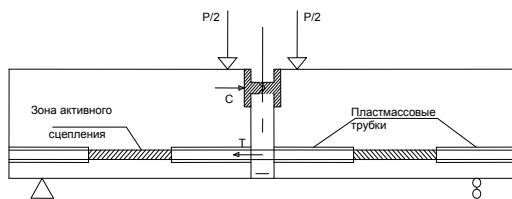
Схема испытания на сцепление арматуры с бетоном
